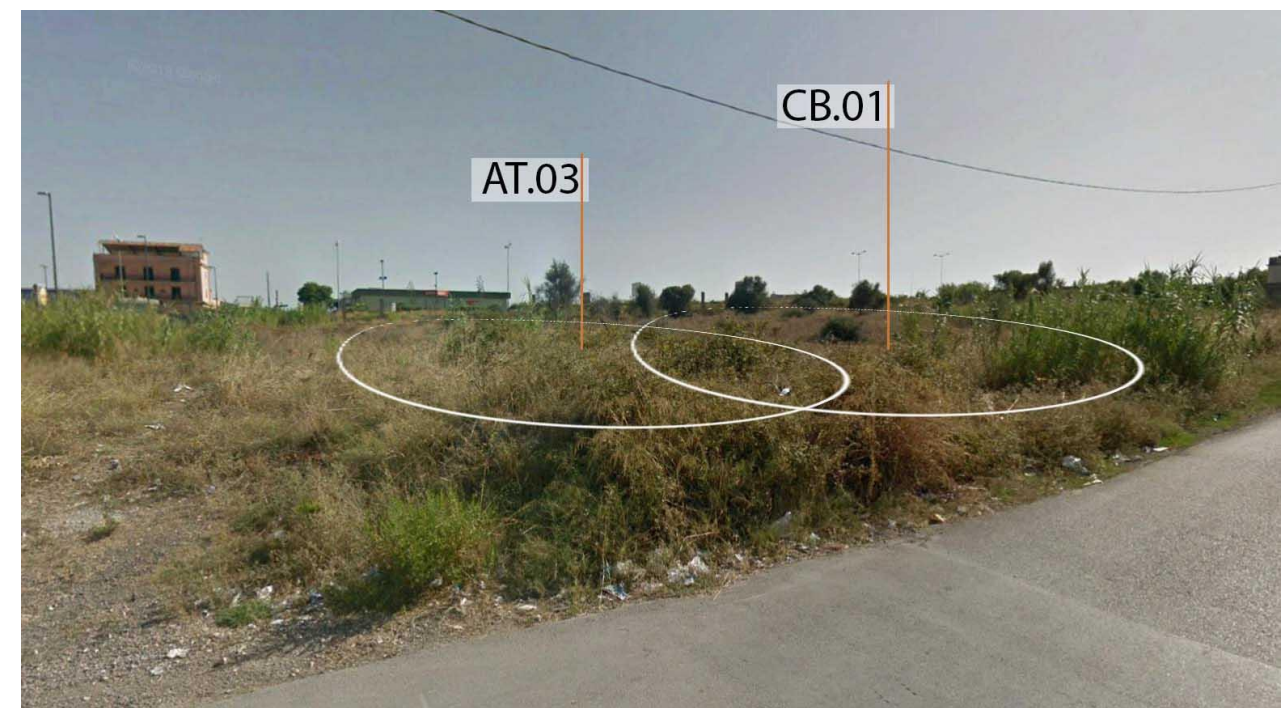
Ambiti olivati interessati temporaneamente dalle aree di cantiere fisso CB.01 e AT.03
